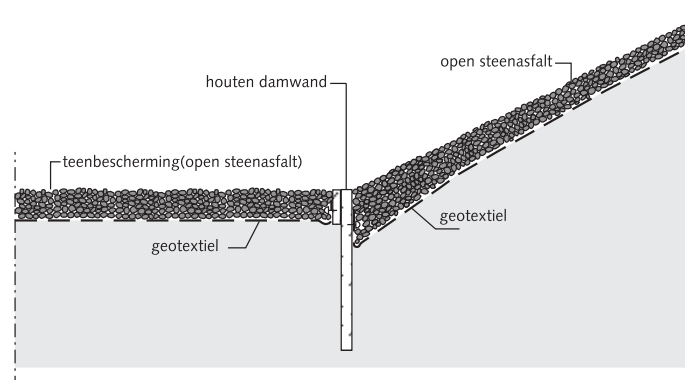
Aansluiting van open steenasfalt op een constructie
